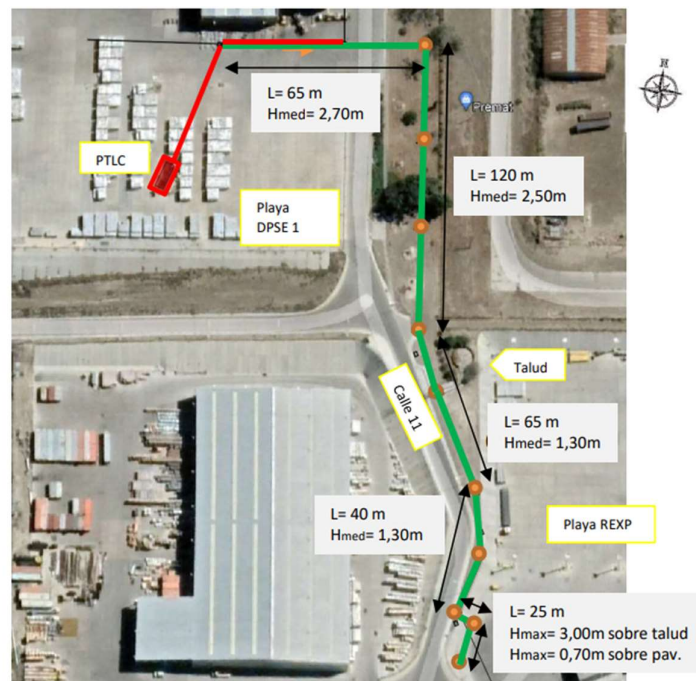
Diagrama del trabajo planificado para la desactivación de la planta cloacal de DPS1, en rojo instalaciones a desactivar, en verde cañería cloacal a construir.
